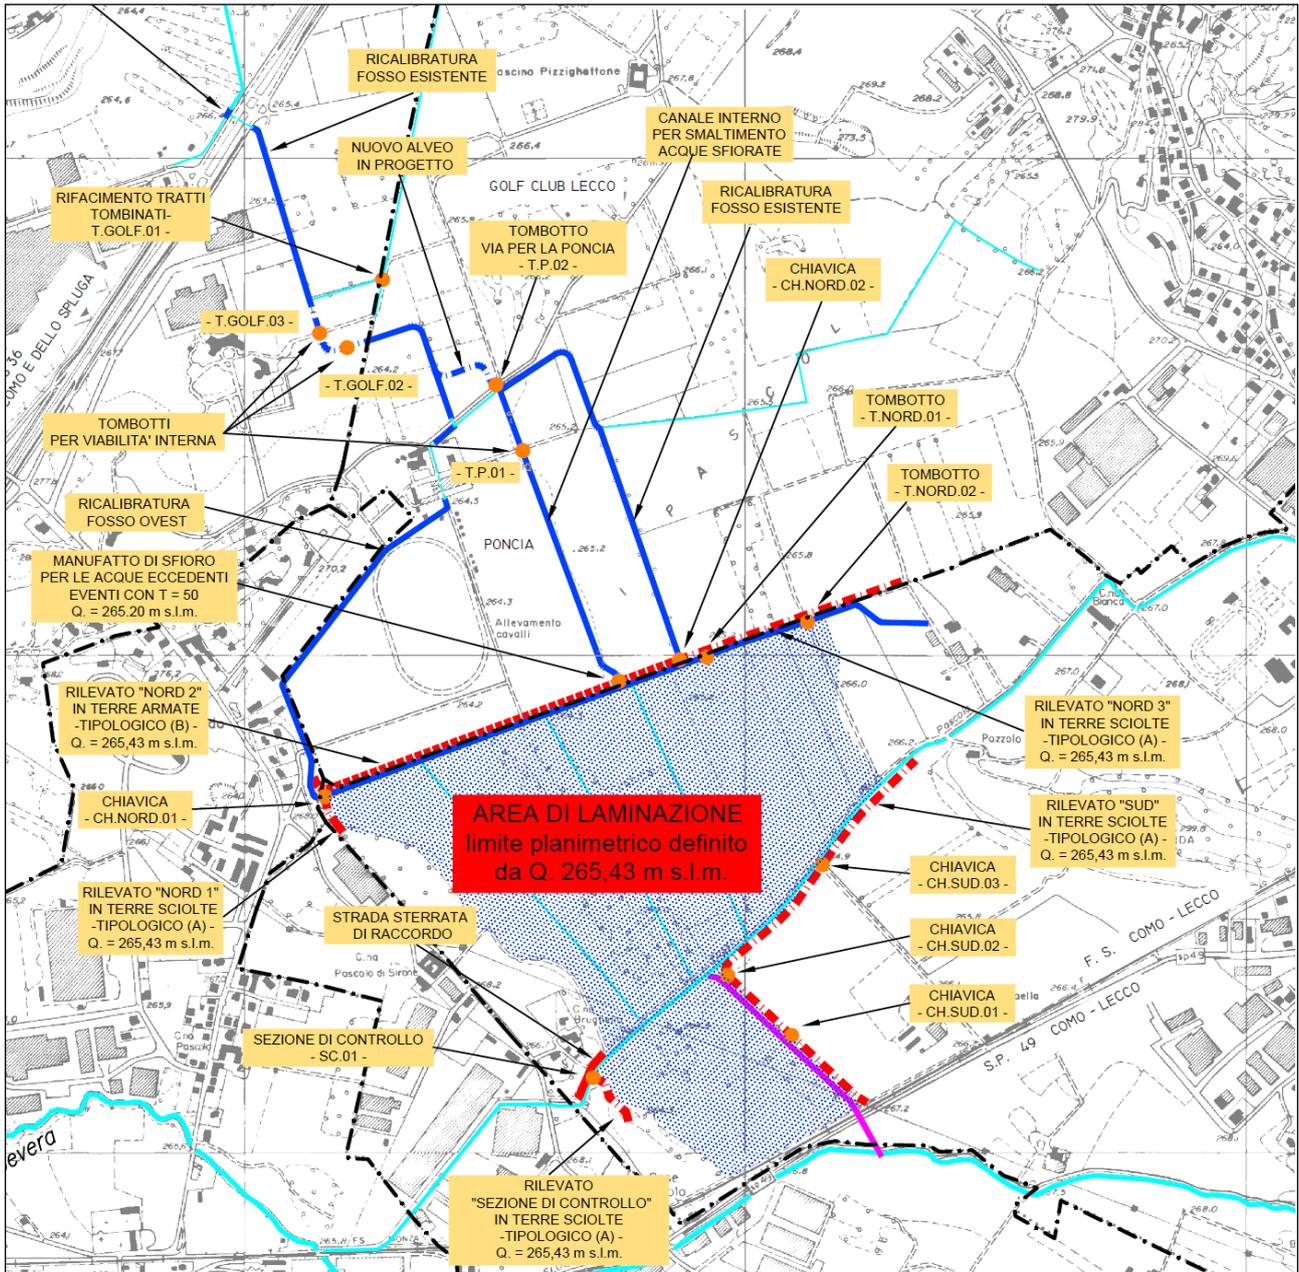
Vista d’insieme (Progetto Definitivo Lotto 2)
